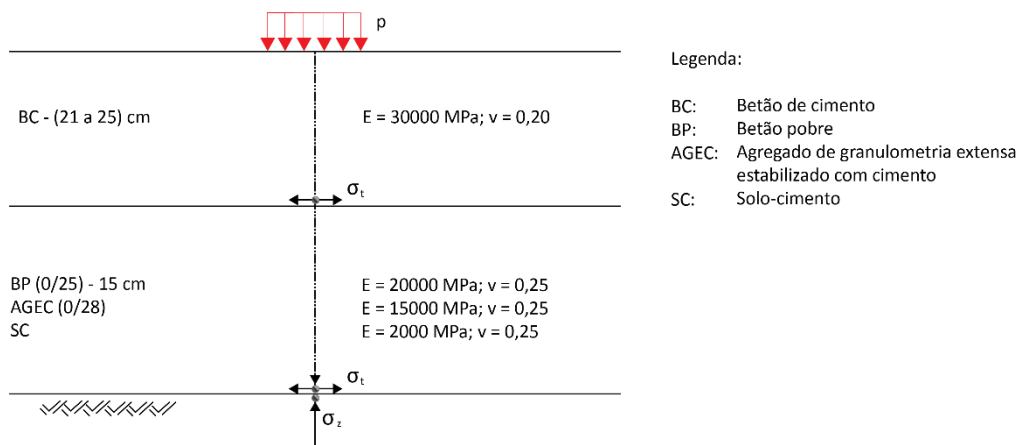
Constituição e comportamento de um pavimento rígido (adaptado de BRANCO, 2008)
